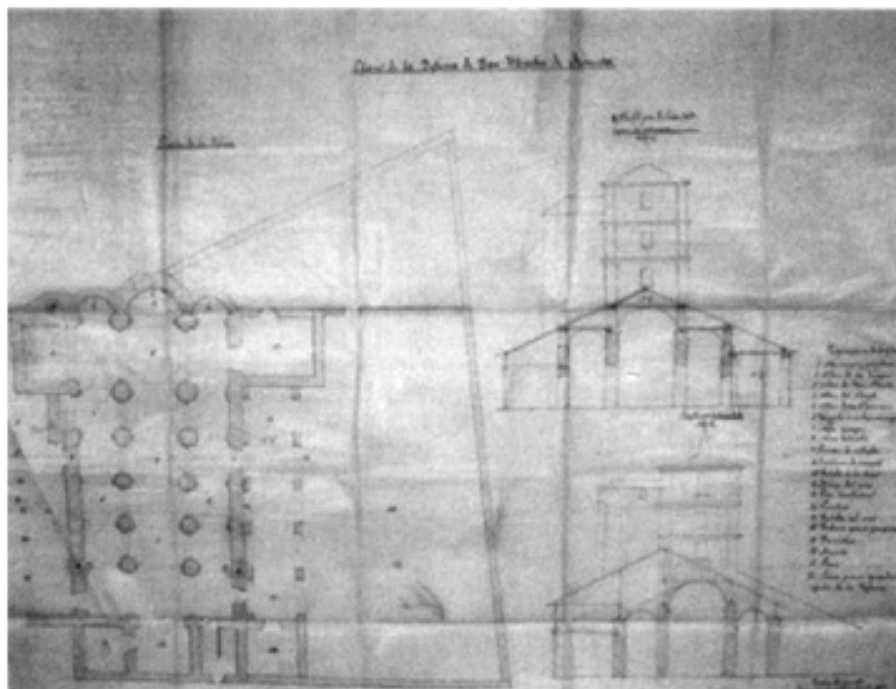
Planta y alzado de San Martín por A. M. Canut en 1878.
